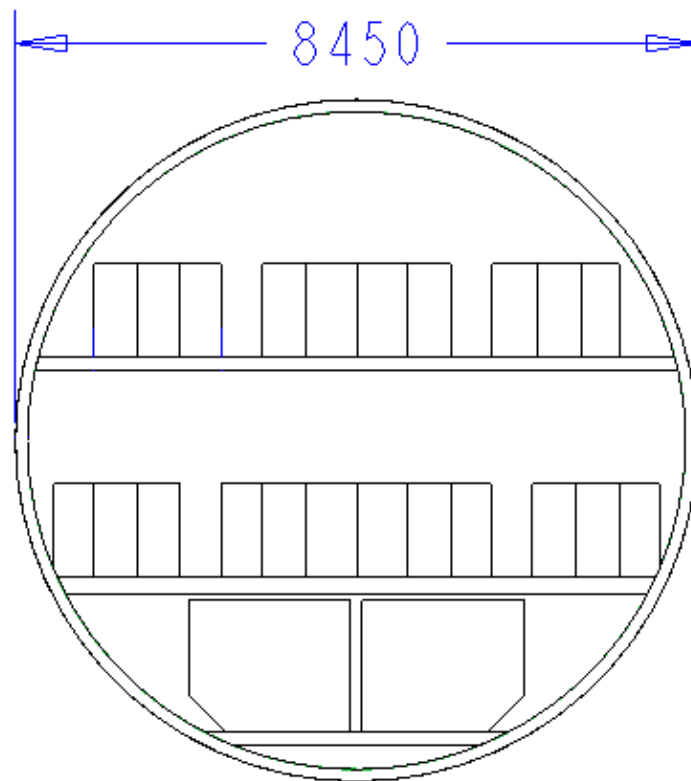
Geometria della sezione retta: sezione circolare, I soluzione
